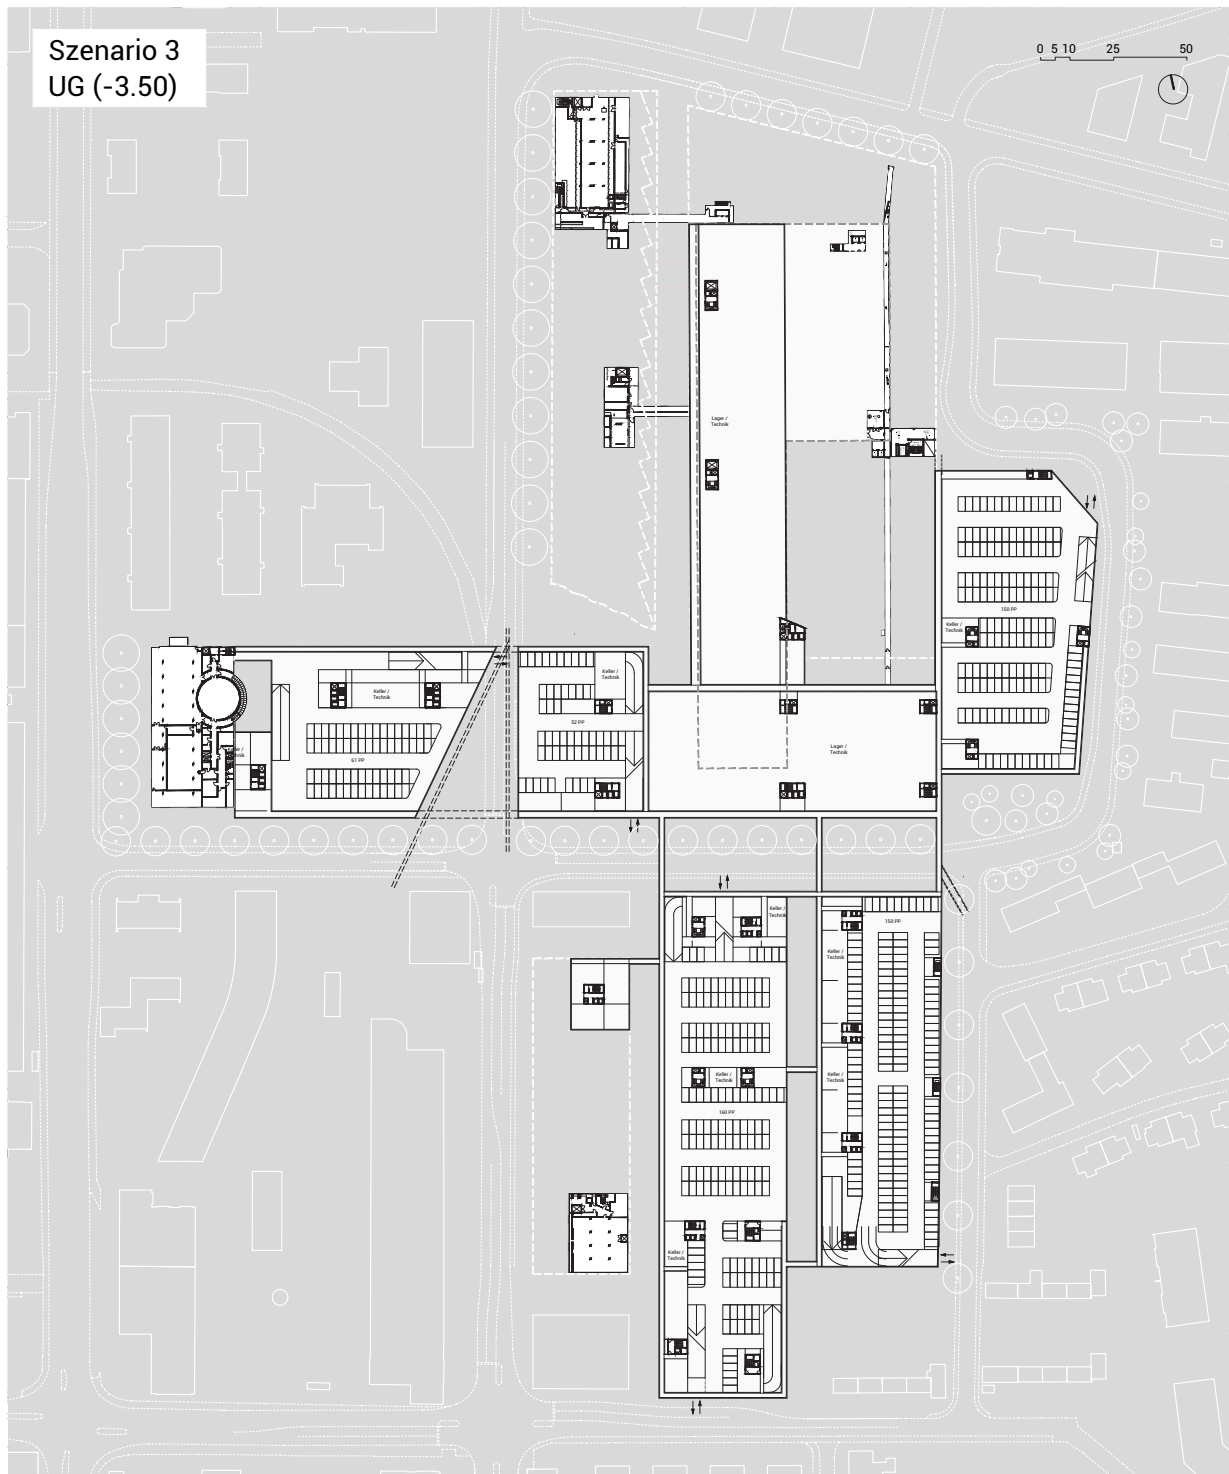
Grundriss UG Szenario 3
